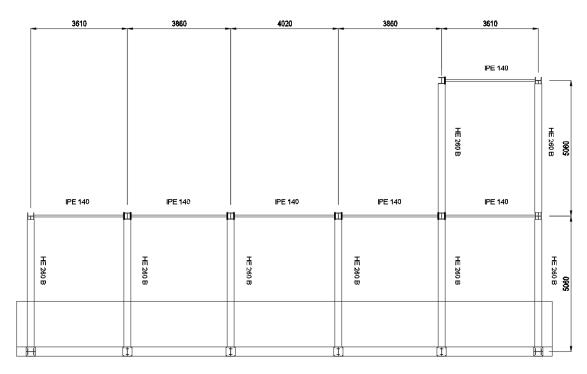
Distancia entre las vigas que forman la segunda planta. Fuente: Elaboración propia.
